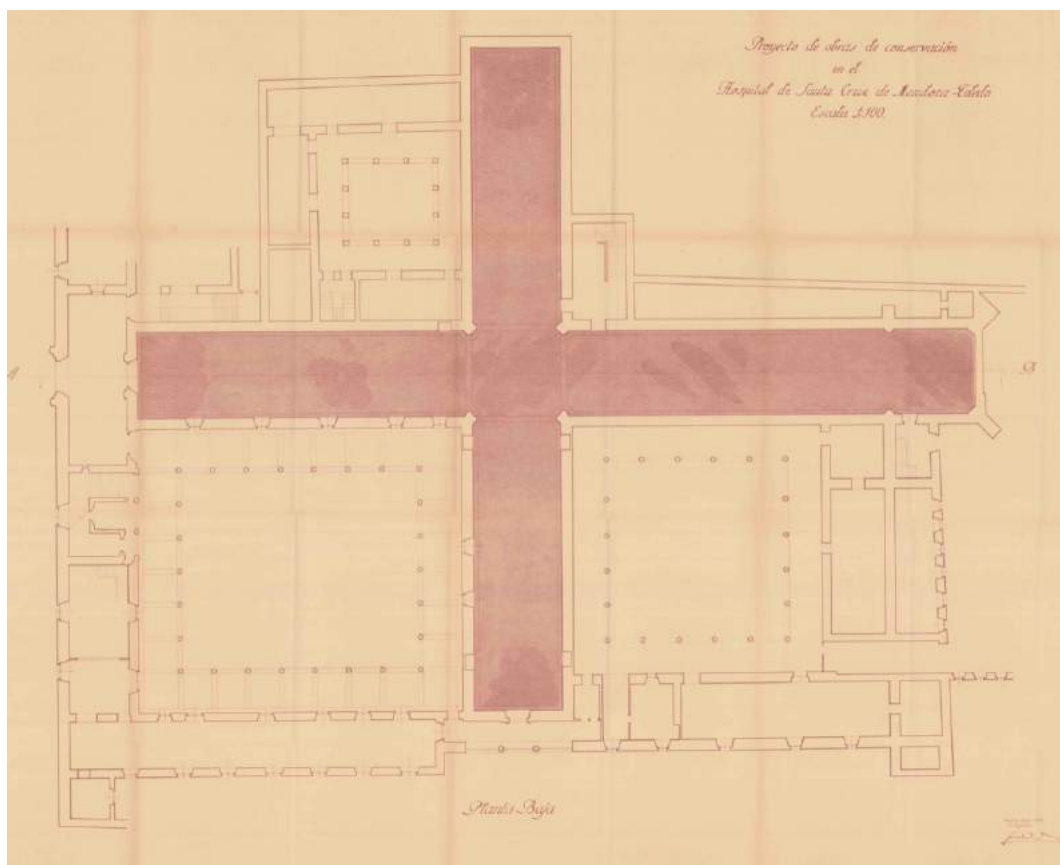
Planta de Santa Cruz de Mendoza. Proyecto de obras de conservación, 1956.
